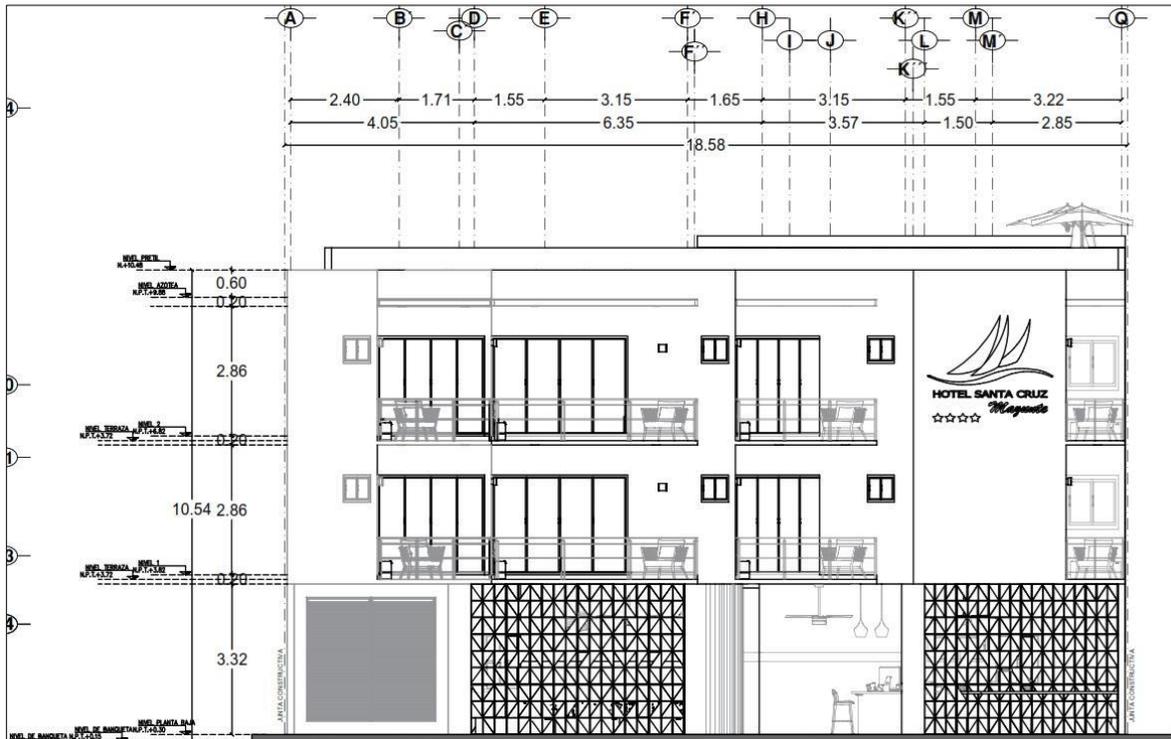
Fachada principal del Hotel Santa Cruz Mazunte.
